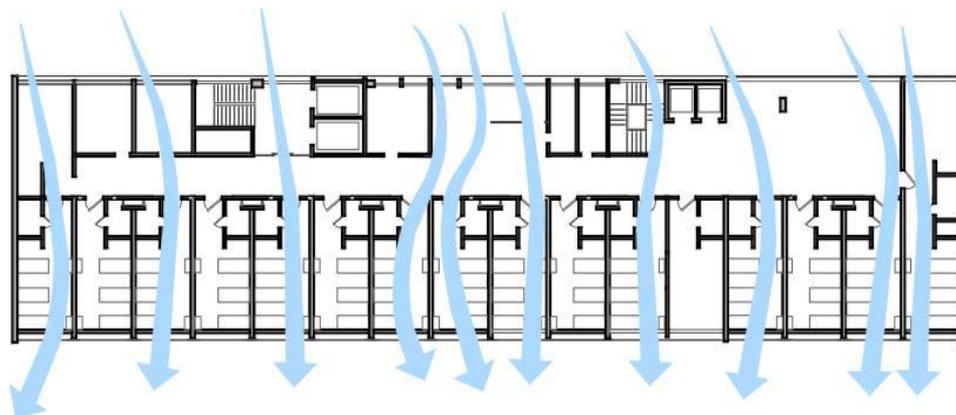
Esquema em planta baixa da ventilação cruzada nas internações
